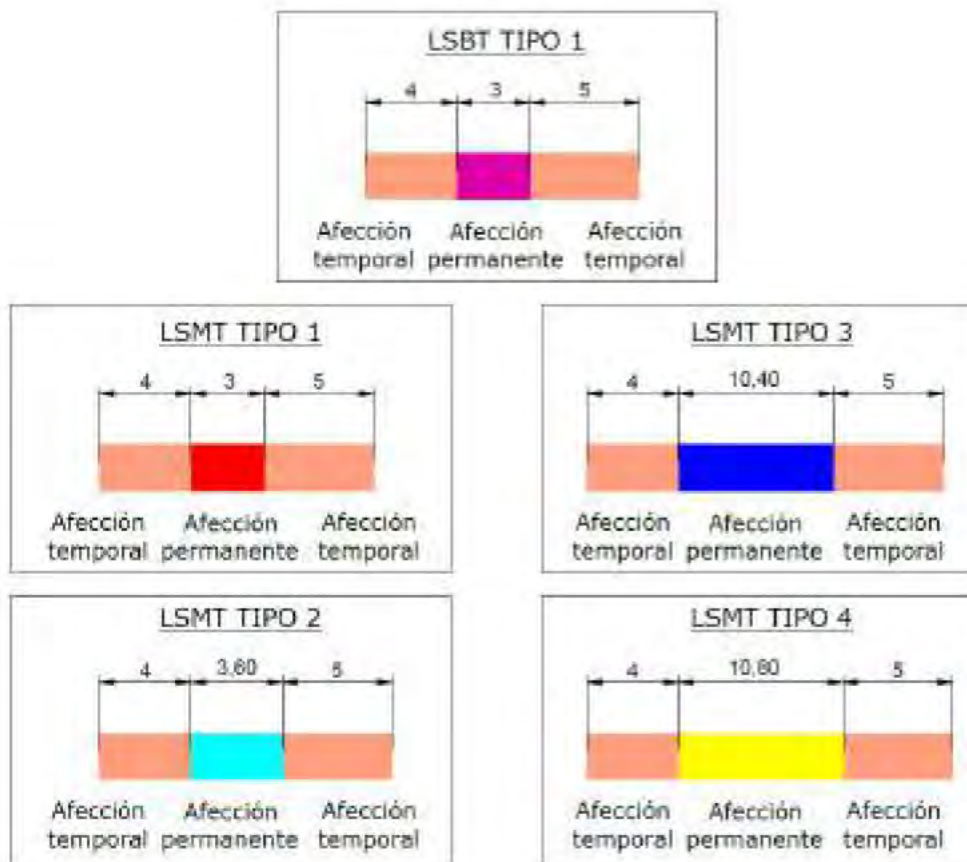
Servidumbres de zanjas utilizadas para el cálculo de la RBDA.
